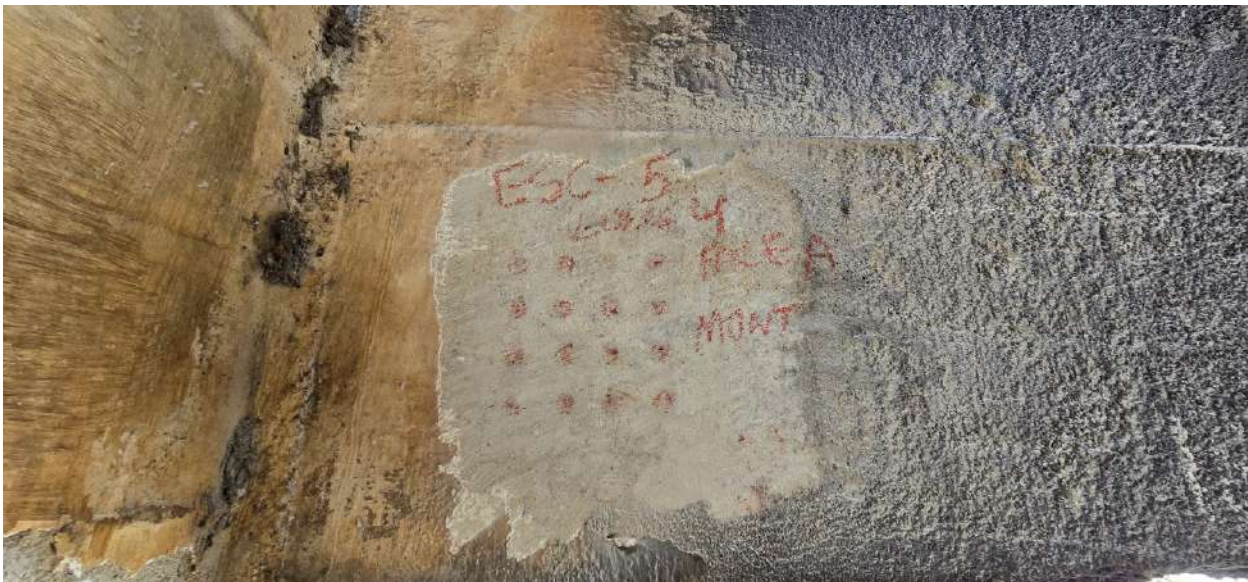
Ensaio de esclerometria ESC-5 na viga longitudinal VL4 face montante vão P2 e Encontro 2
